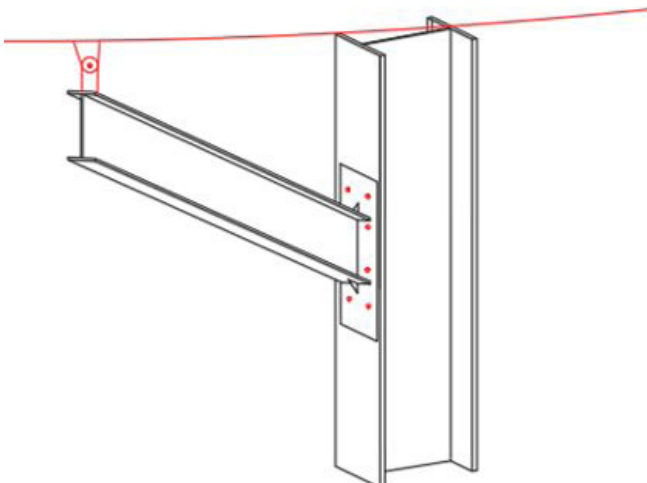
Detalle anclaje viga, columna y cerchas metálicas.
